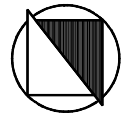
Grundriss (unmaßstäblich)
